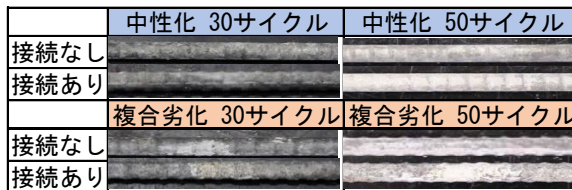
亜鉛めっき鉄筋の腐食状況 (促進試験)
